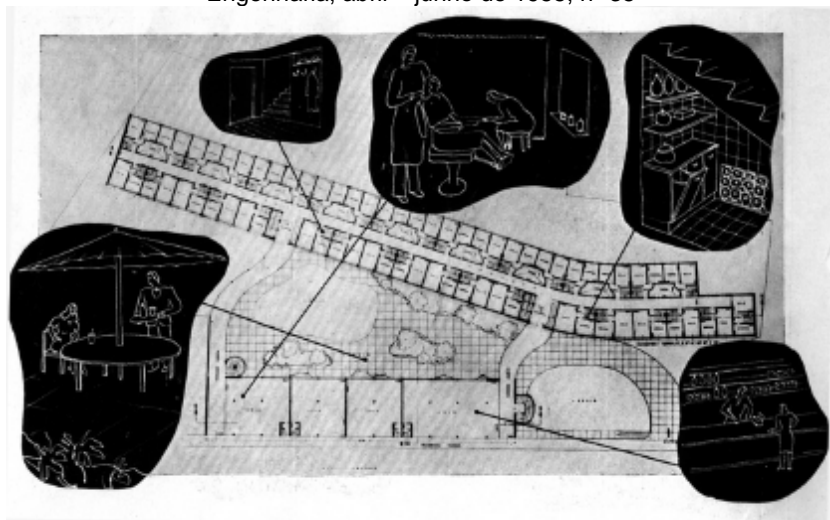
Plantas do apartamento duplex do Conjunto Japurá. Fonte: Revista Arquitetura e Engenharia, abril –junho de 1955, nº 35
